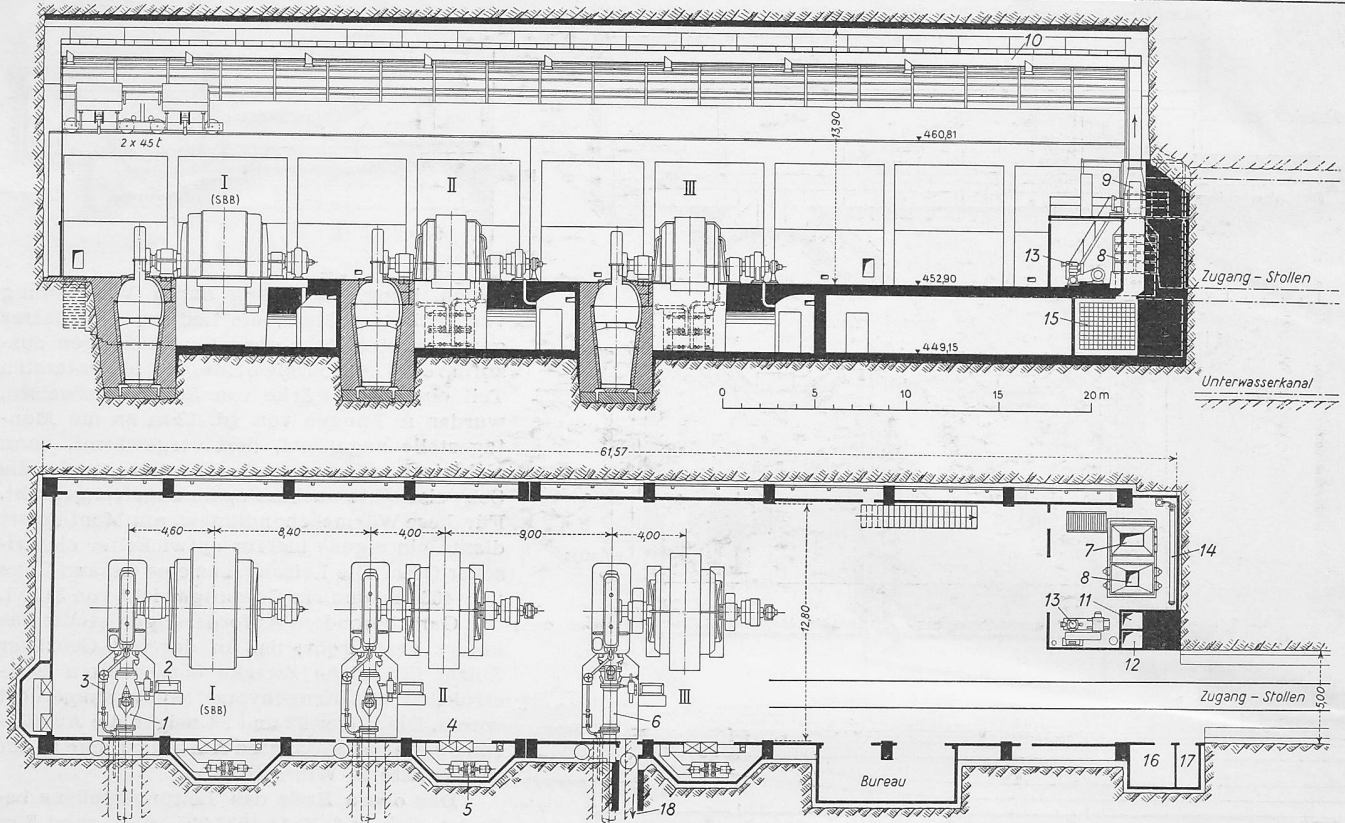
Unterirdische Kraftzentrale Miéville, Grundriss und Längsschnitt, Masstab 1: 400
